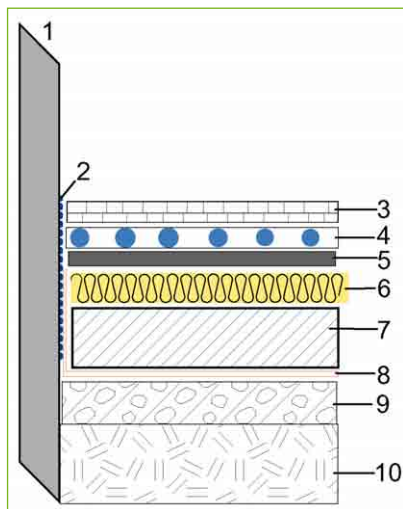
Prinzipaufbau von Heizung und Dämmung mit den folgenden Elementen: 1) Hauswand, 2) Trennlage, 3) Bodenbelag, 4) Bodenheizung, 5) Estrich, 6) Dämmung, 7) Betonplatte, 8) PE-Folie, 9) Frostschuttschicht aus Kiessand 10) Erdreich.
